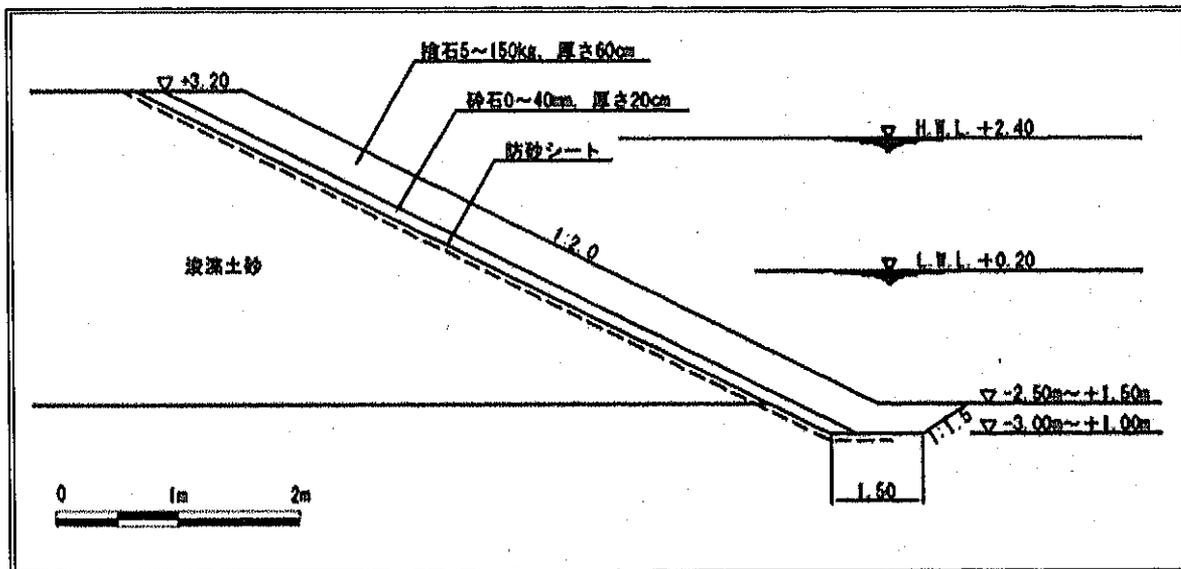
(6-2) 護岸標準断面図 (護岸B: 埠頭西側端部)
